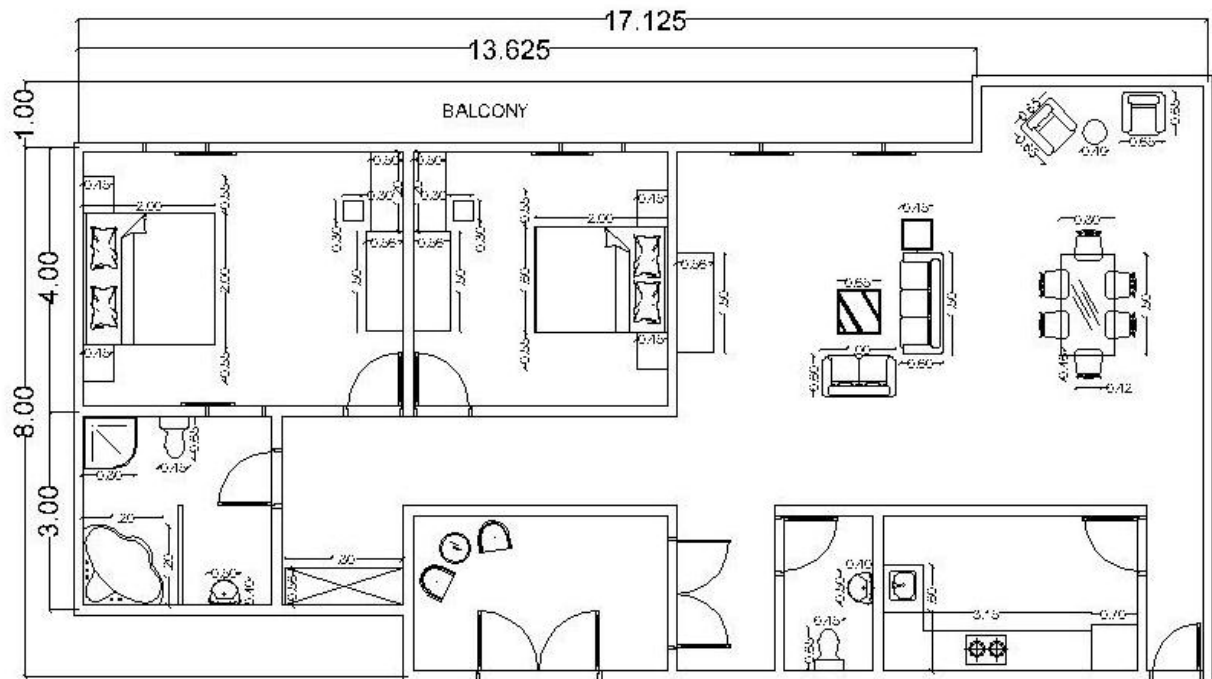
Studi Ruang Kamar Tamu Tipe *Deluxe Room
